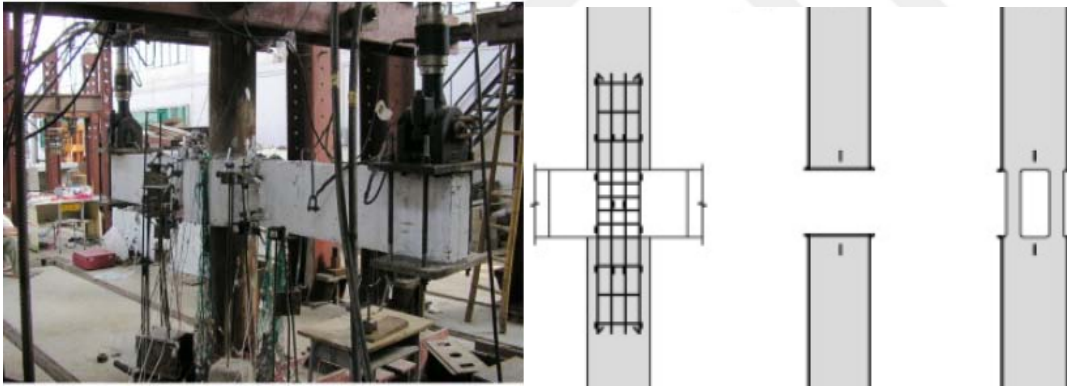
Betonarme-çelik kompozit kolon-çelik kiriş birleşim detayı (Zhang vd., 2012)
